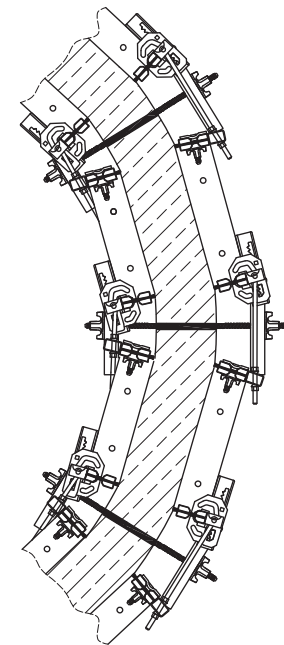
Demontaż segmentu wewnętrznego.
